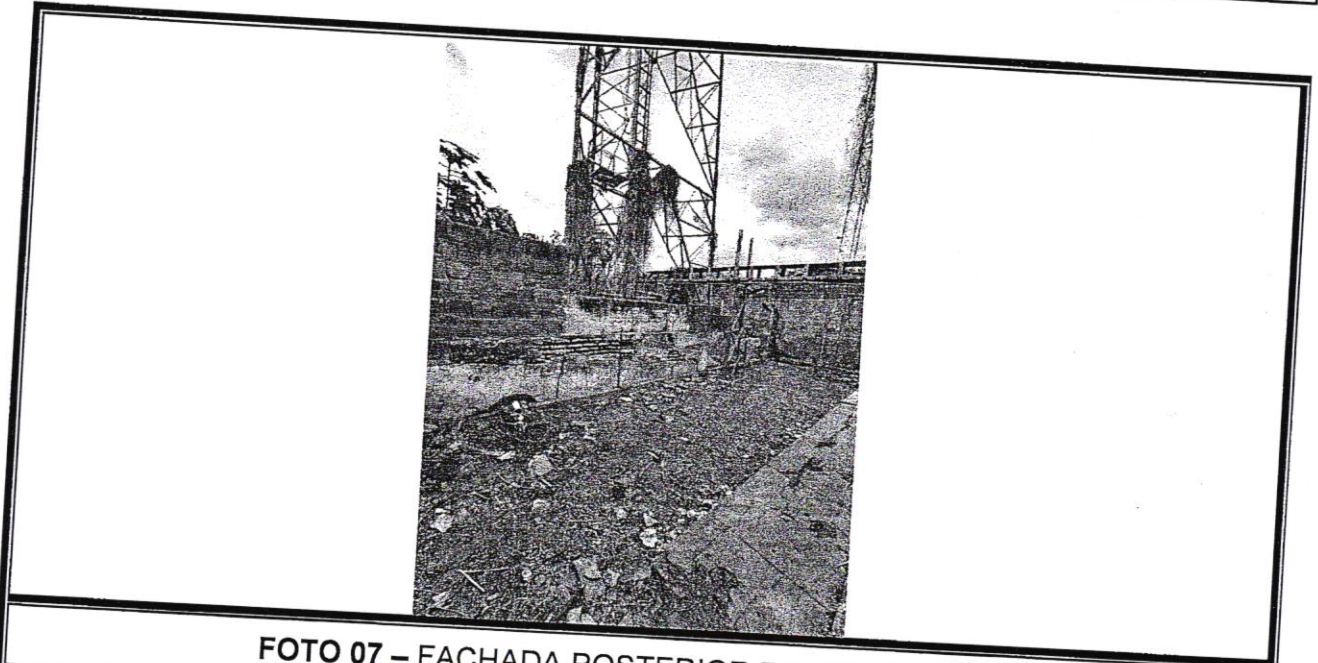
FACHADA POSTERIOR DA EDIFICAÇÃO
